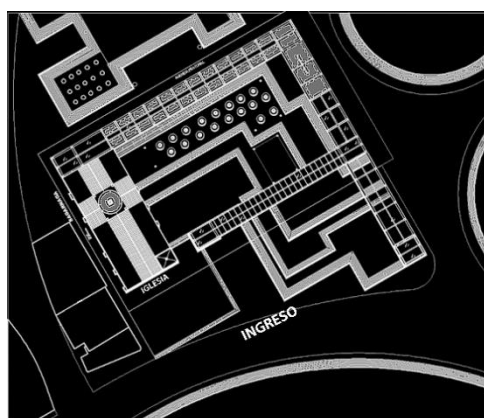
Planta de proyecto de implantación en La Paz, San Francisco. Fuente: elaboración propia (2004).
